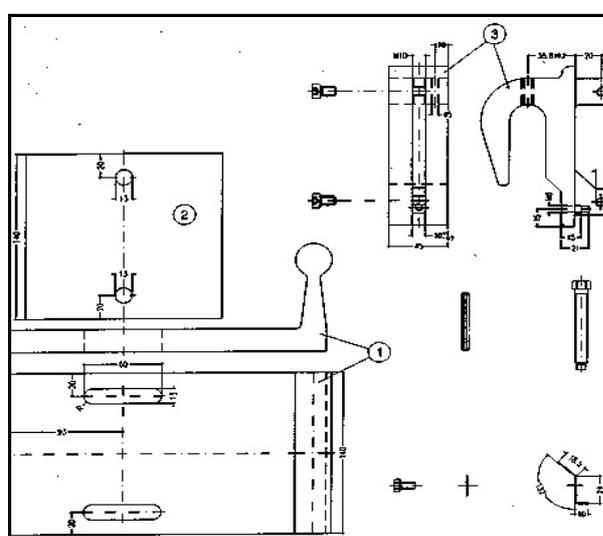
Componentes do sistema: 1 - Elemento de fixação dos painéis (ancoragem); 2 - Base soldada ao inserto para apoio da ancoragem; 3 - Gancho para encaixe do caixilho ao elemento de fixação. Fonte: Machado (2004)
